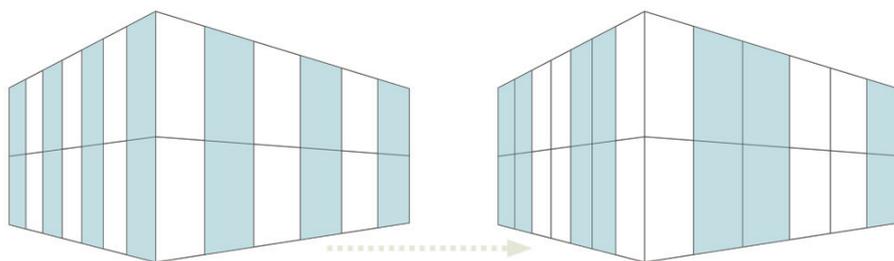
Adattabilità di facciata modulare (fonte: elaborazione dell'autore)
